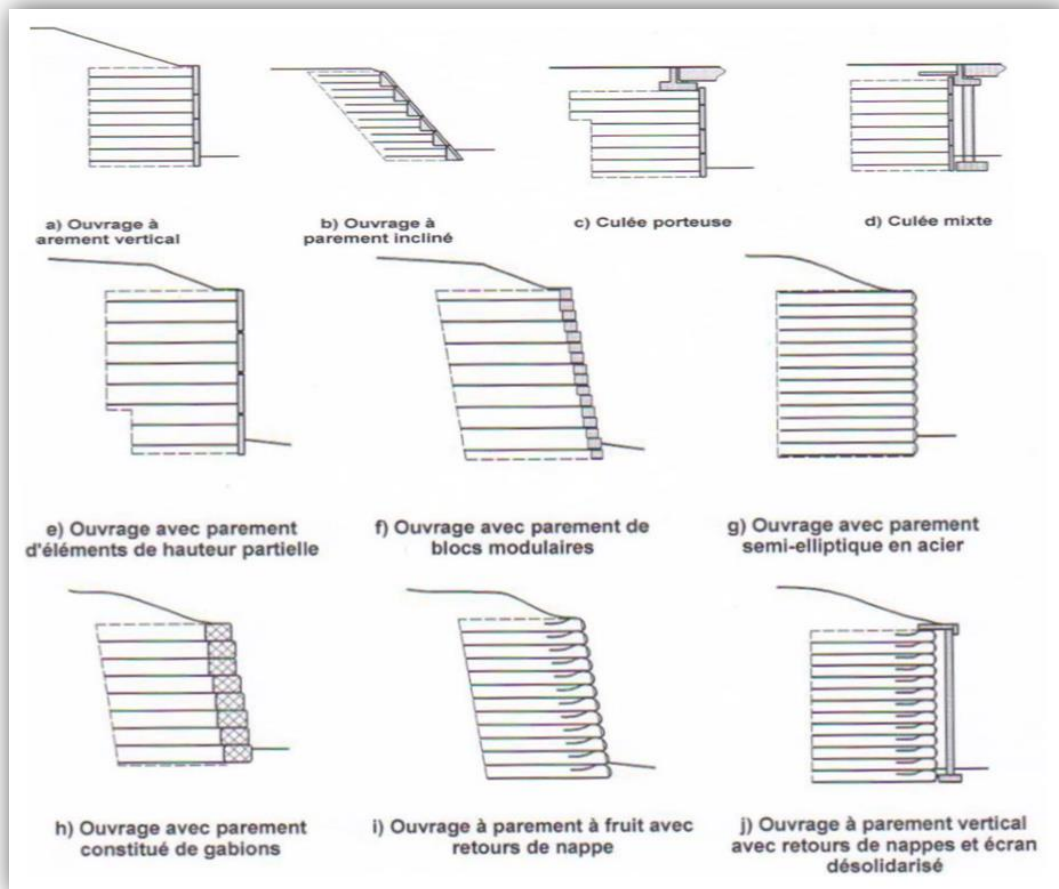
Exemples d'ouvrages en remblai renforcé (NF P94-270, 2009)
